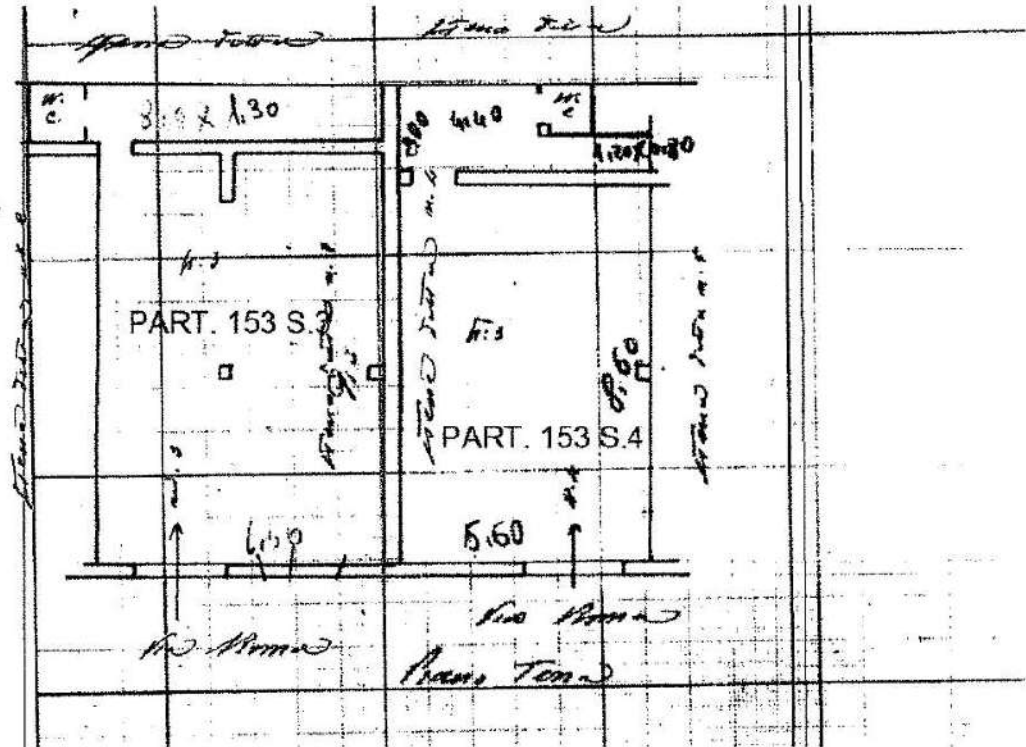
Elaborazione Planimetrie catastali sub 3 e 4
